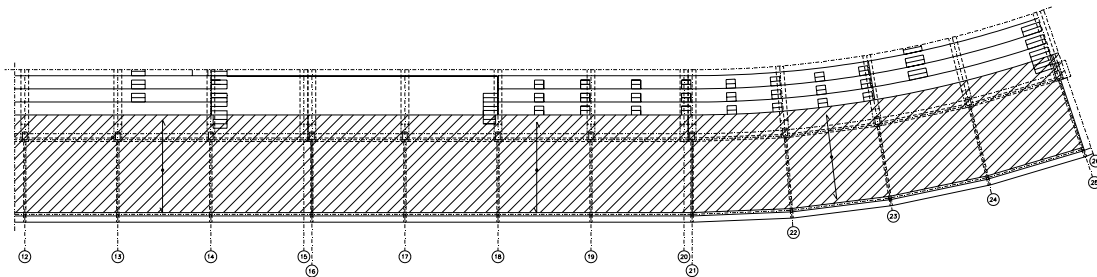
Disposición de juntas de dilatación en el forjado mixto de la crujía nueva
